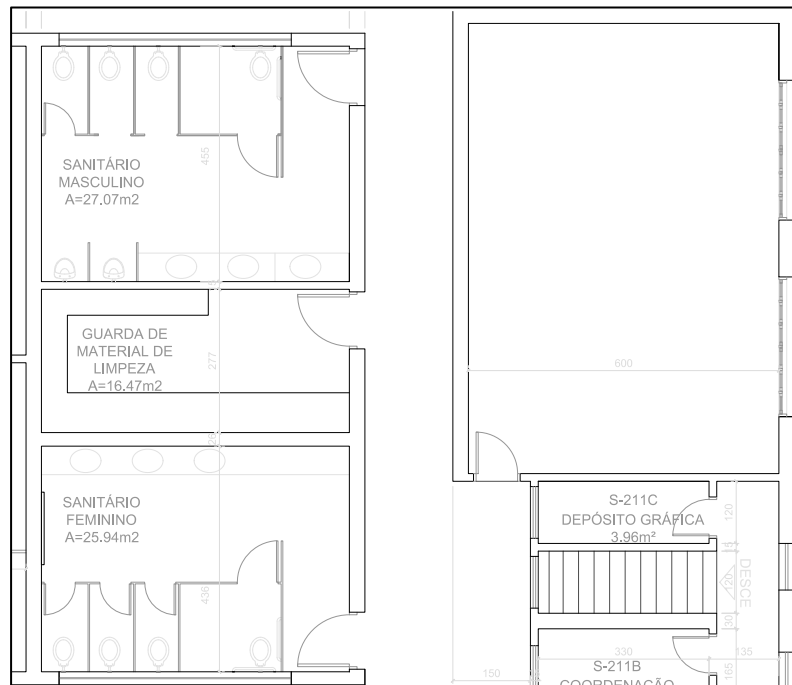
Instituto Federal de Goiás – Banheiros pavimento superior – Localização. Fonte: Projeto arquitetônico.
